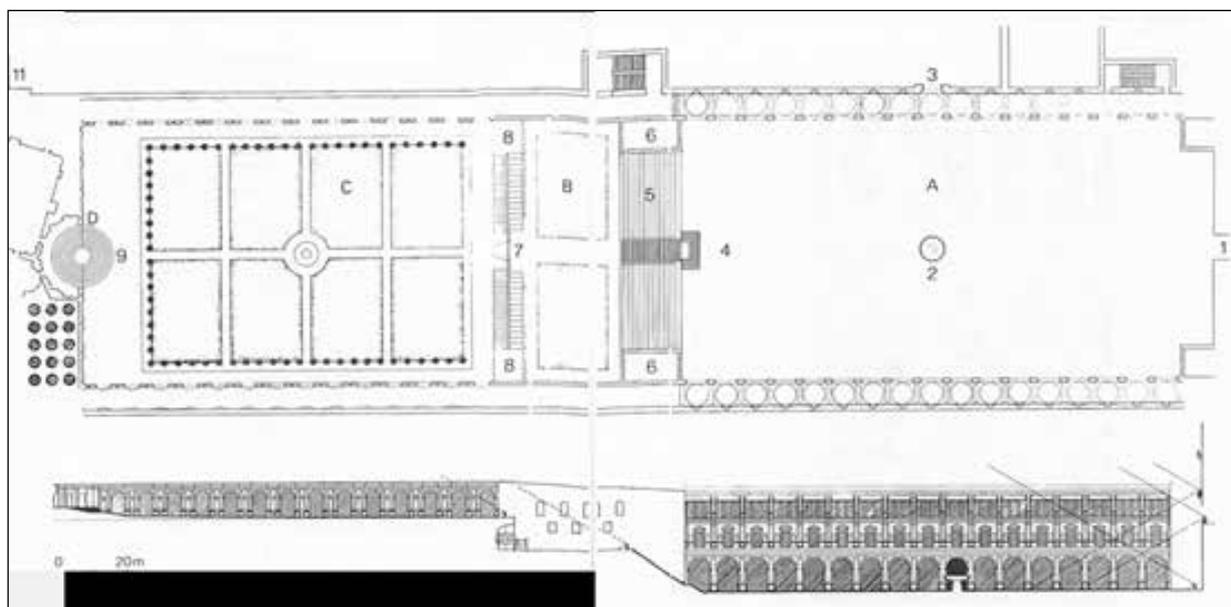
Bramante: Pátio do Belvedere (planta e corte do projeto). Fonte: Bruschi.
